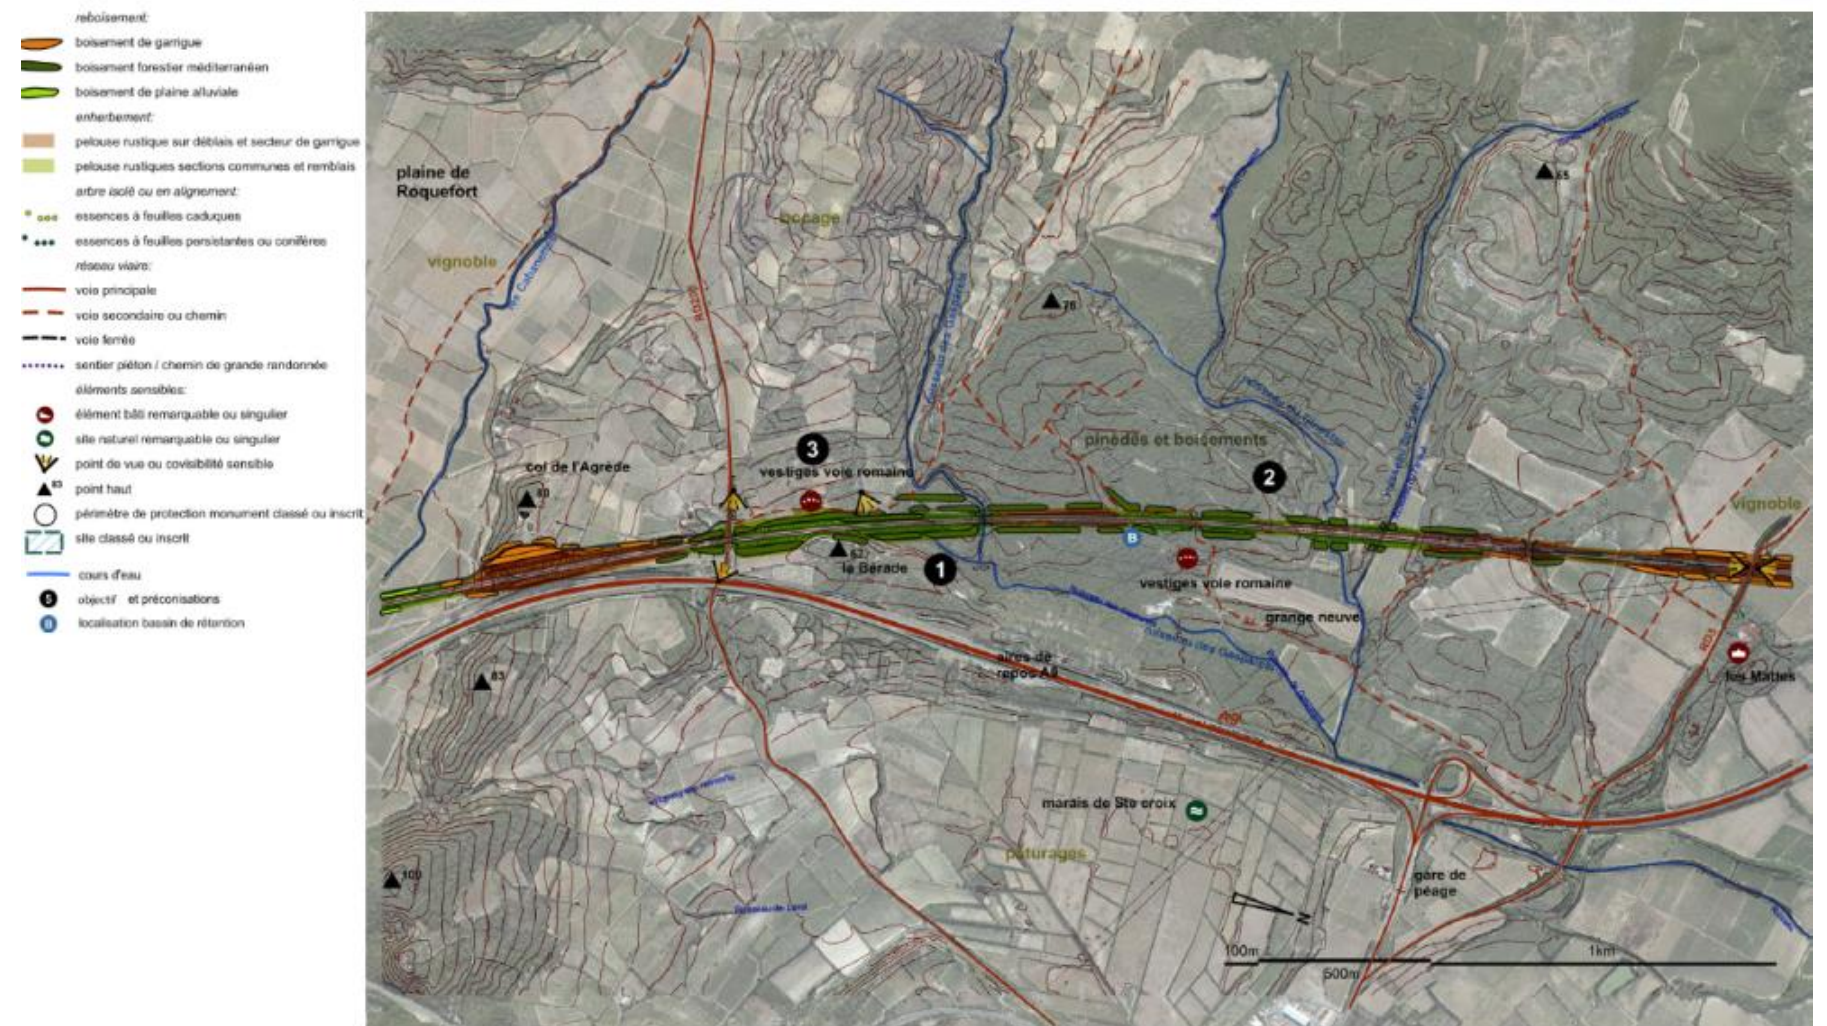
plan des mesures paysagères dans la traversée du bocage de Sigean (source : Traverses)
